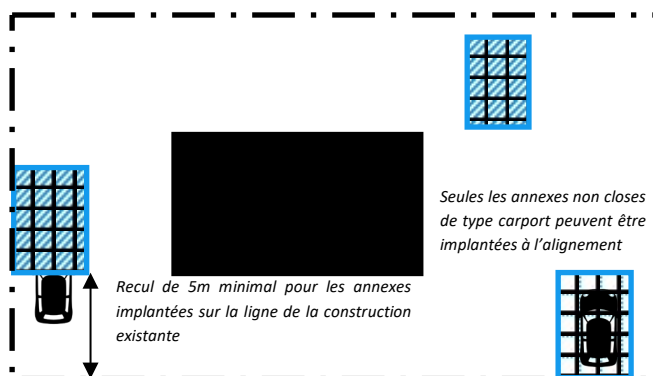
zones d'implantation possibles pour les annexes de la construction existante
